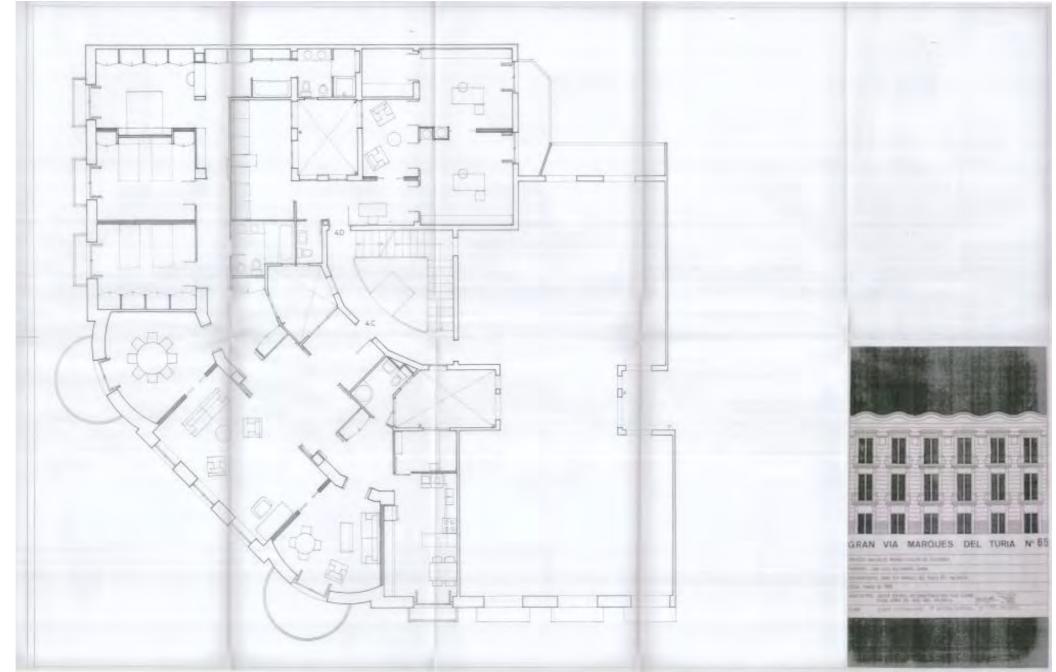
Planta cuarta estado proyectado, rehabilitación 1985
